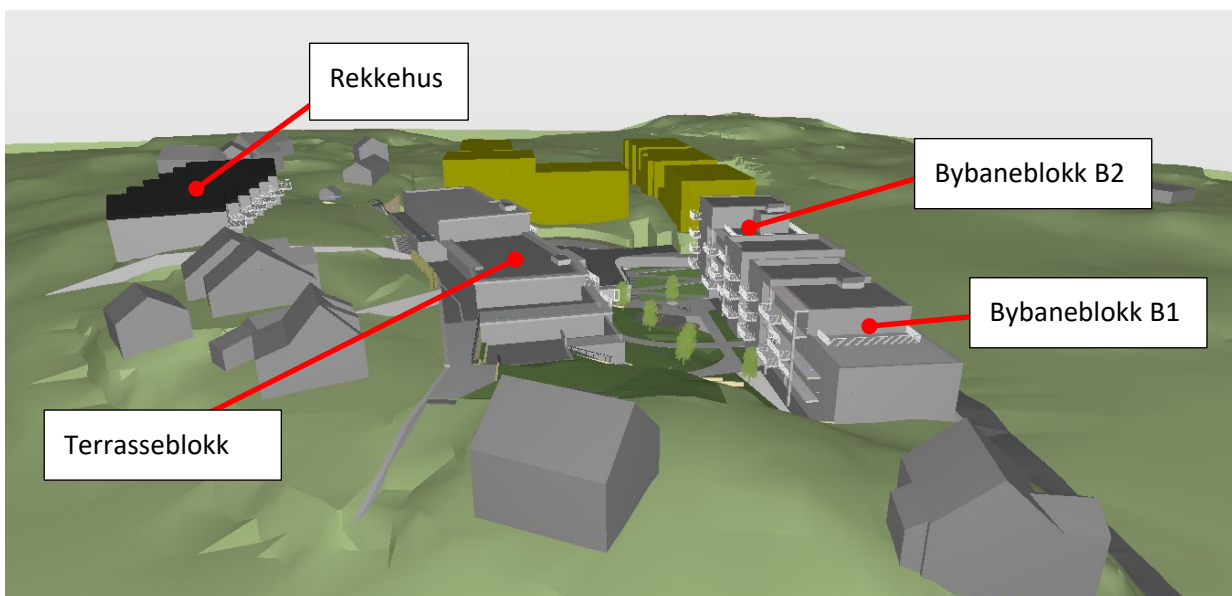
Situasjonsplan. Planområdet ligger innenfor rød linje. «Bybaneblokk-B1», «Bybaneblokk-B2», «Terrasseblokken», og «Rekkehus» er planlagt 4 boligblokker.
